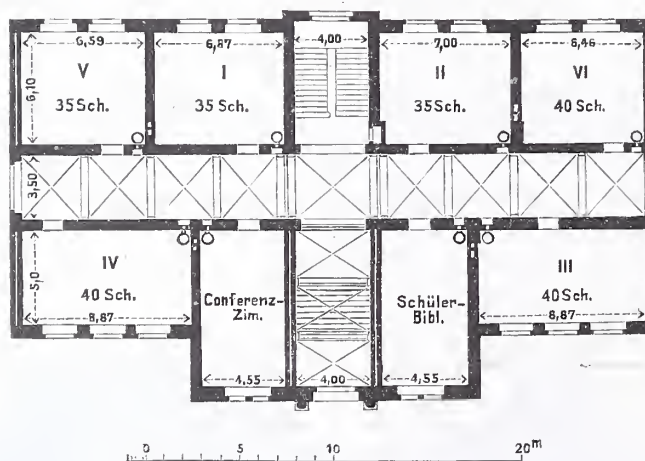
Grundriss vom Erdgeschoss.
